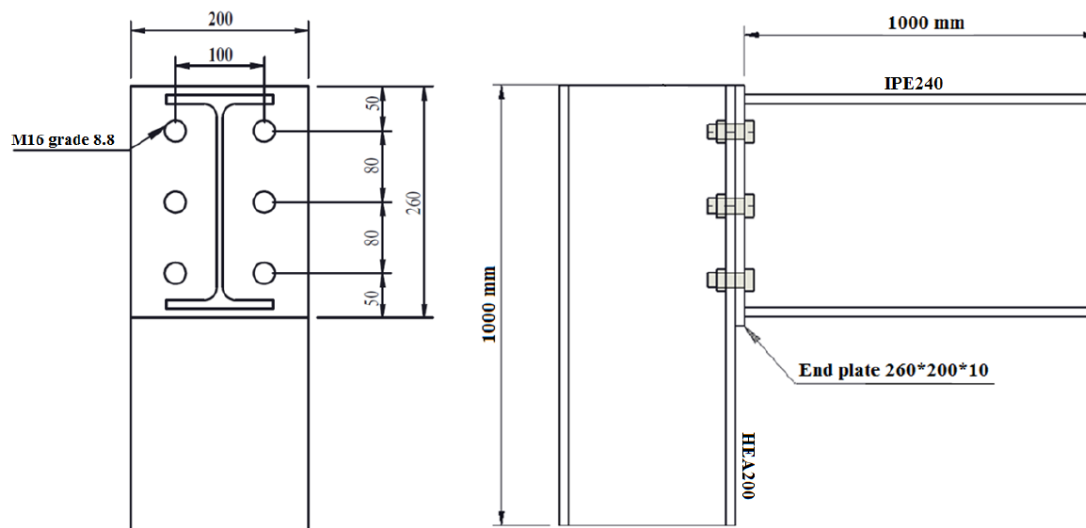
Assemblage poteau-poutre avec platine d'extrémité non débordante et des boulons M16
